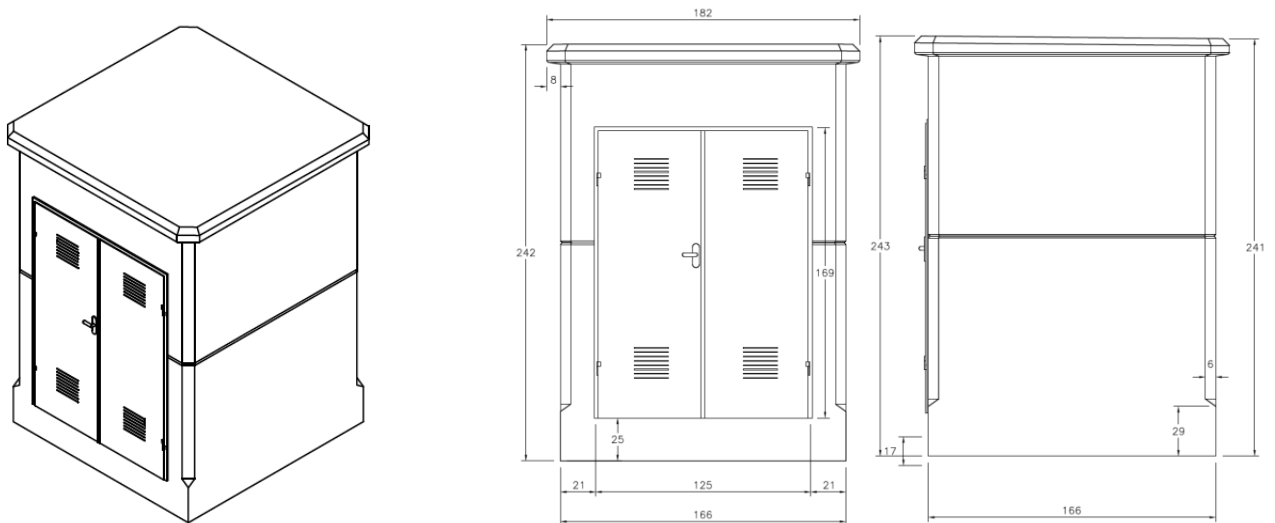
Vistas caseta recomendada hidrante tipo "Costella". Vistas alzado y lateral.
